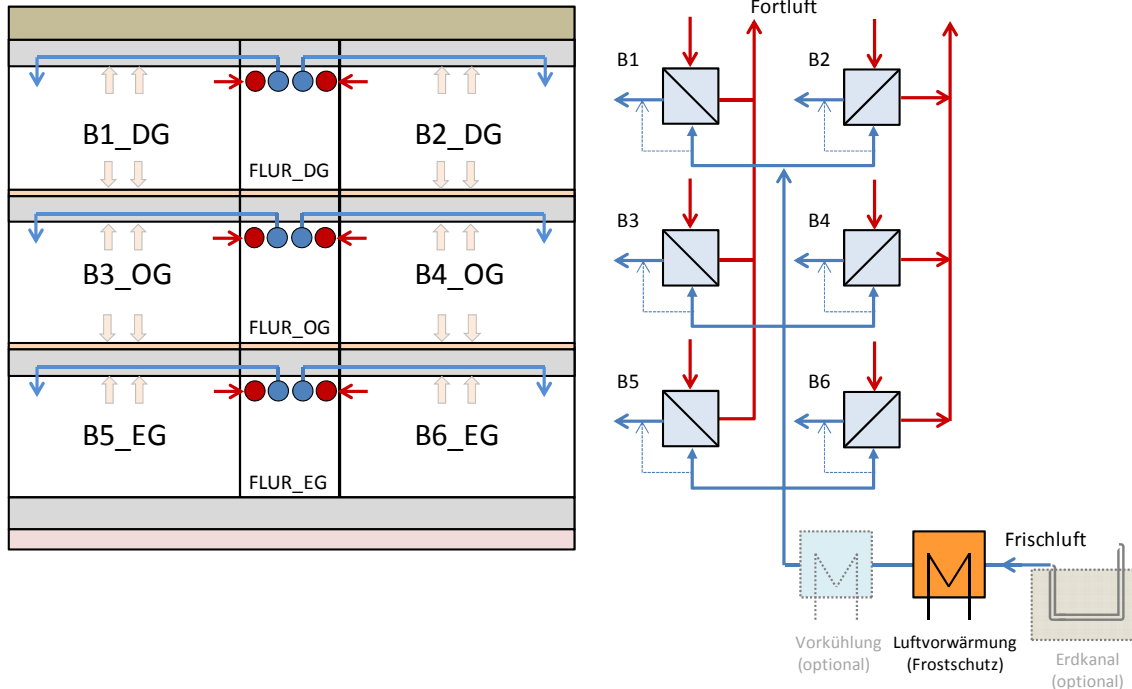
System mit luftgestützter Betonkernaktivierung
